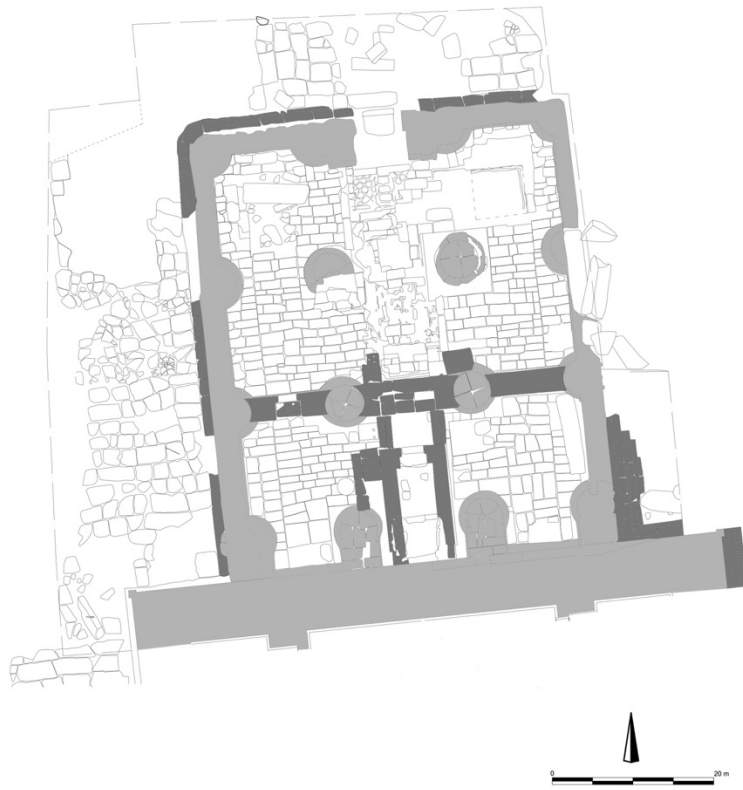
Pianta del *contra-temple* con i pavimenti esterni.
